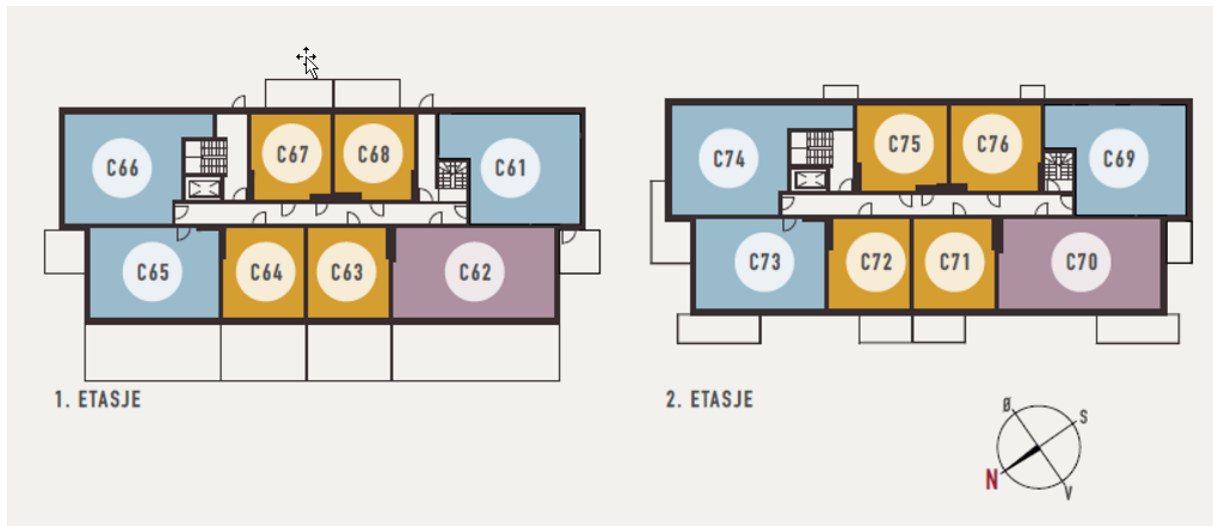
Ladebyhagen. Oversiktsbilde fra salgsprospektet
